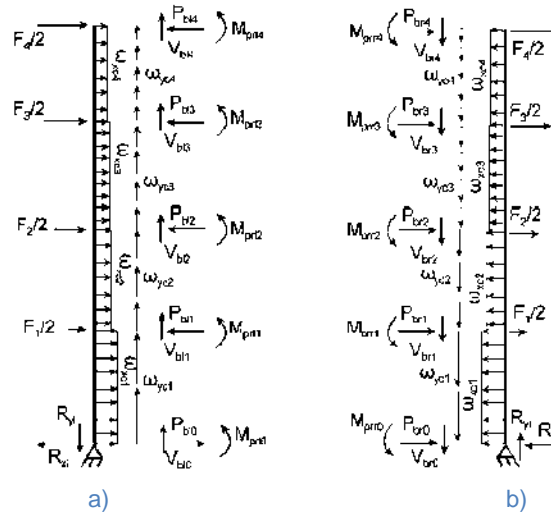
f Fuerzas actuando sobre VBE, a) columna izquierda, b) columna derecha.
